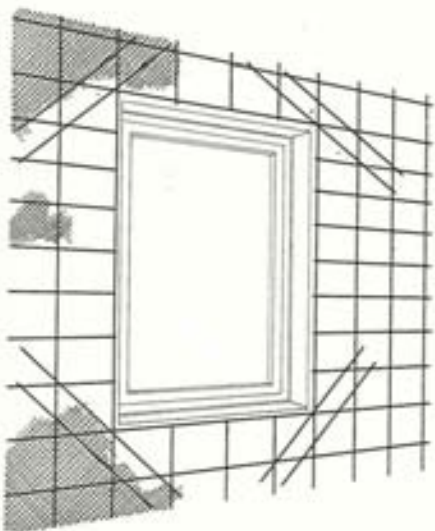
Armering mod hjørnerevner ved muråbning.
